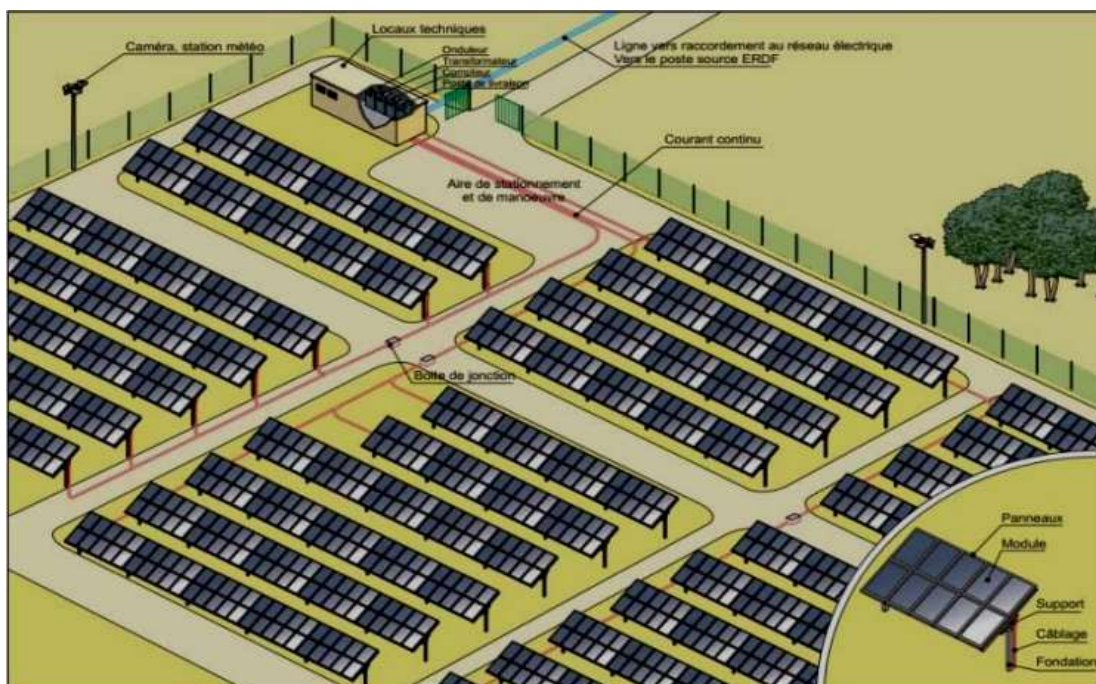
Plan d'implantation de la centrale solaire de 2 MW (SPEN 2023)
